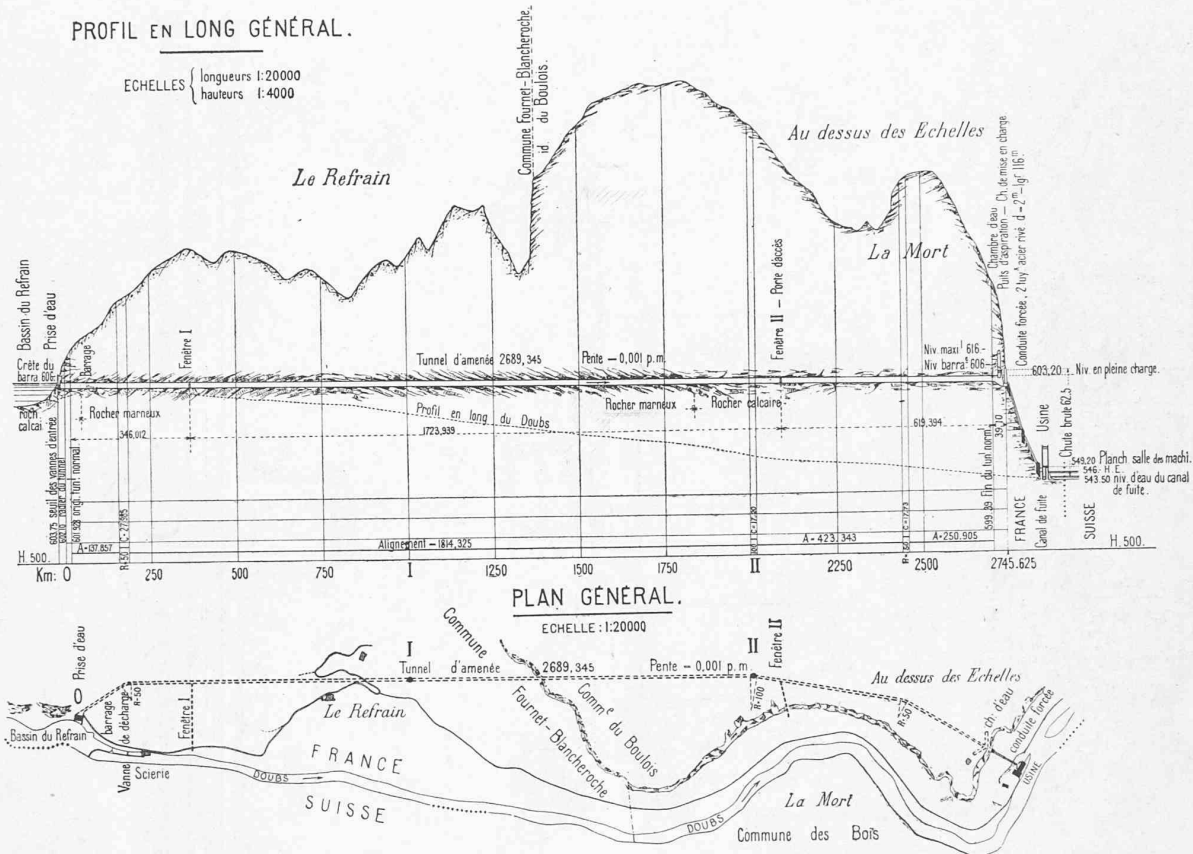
USINE DU REFRAIN. — Plan et profil en long du tunnel d'aménée.
